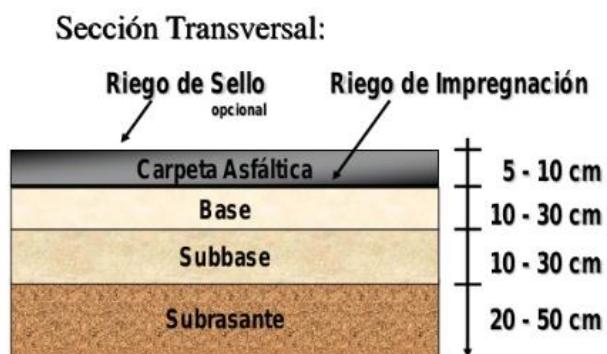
Sección transversal del Pavimento Flexible
